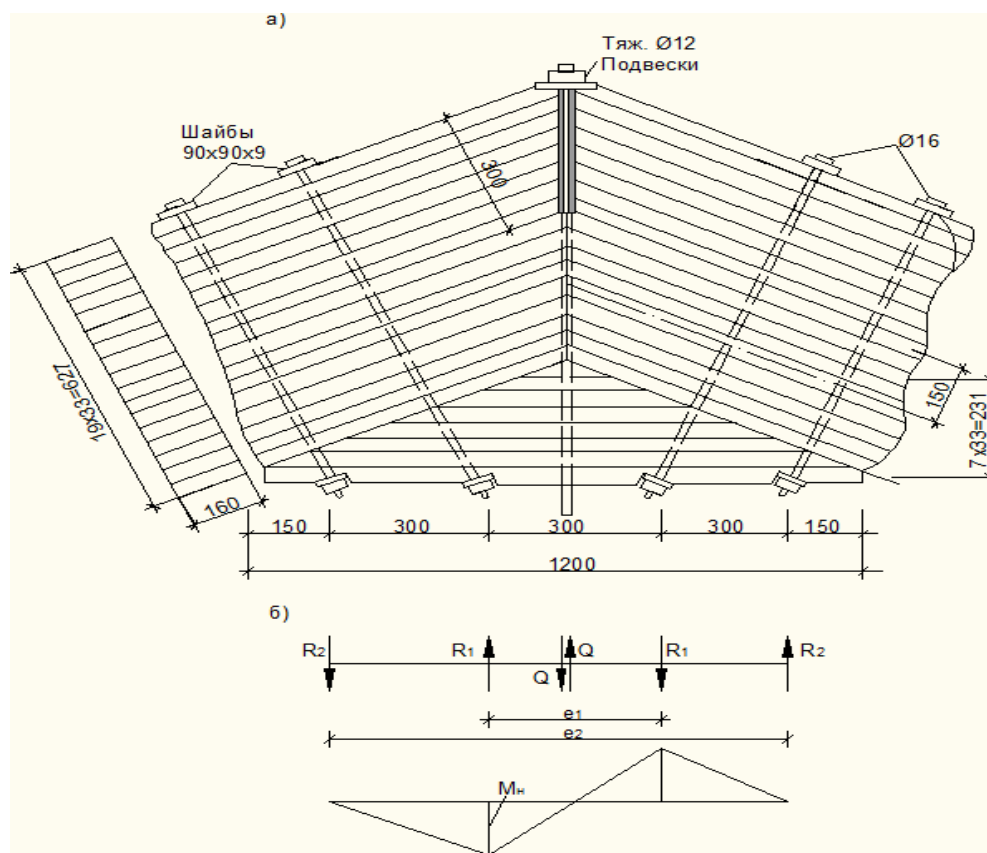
Коньковый узел распорной системы: а – конструкция; б – к расчету усилий в болтах
